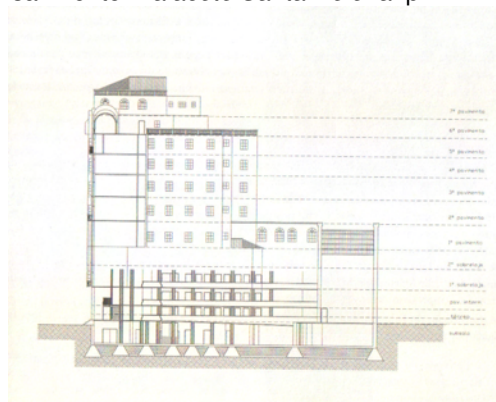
Corte longitudinal. Fonte: *Palacete Santa Helena*. p. 22
